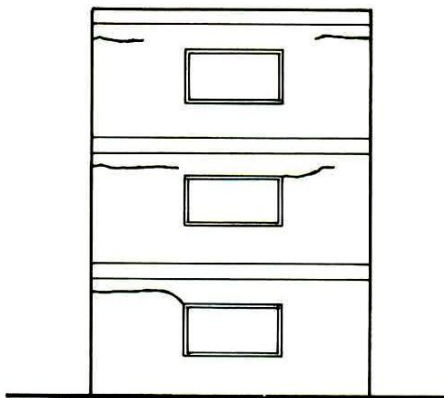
Fissura horizontal causada pela retração de secagem da laje de concreto
